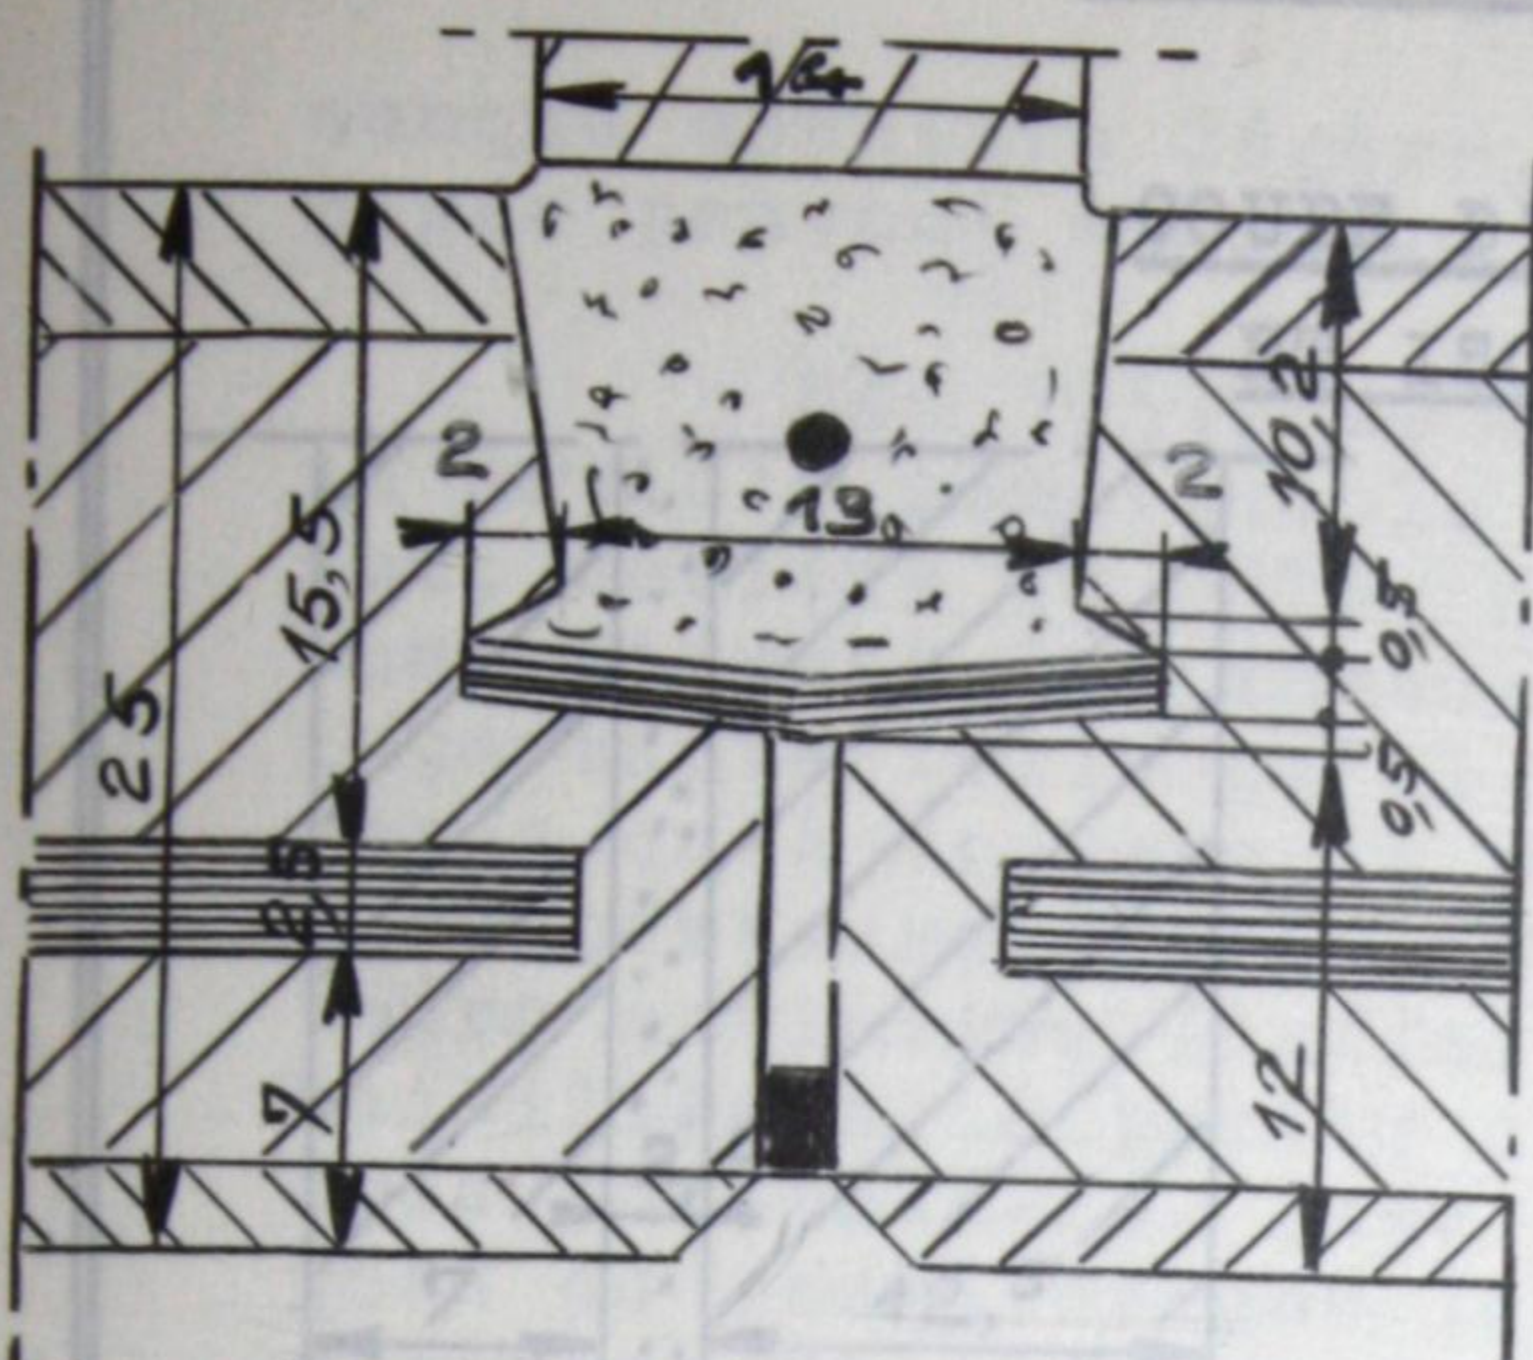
L'isolation thermique est continue. Au droit des potelets verticaux, une plaque d'isolant (polystyrène expansé) coupe le pont thermique.
